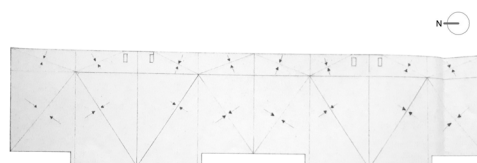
Plano de cubierta plana del edificio situado en la Rúa Moaña - Coia, 6 (fotografía de autoría propia).
